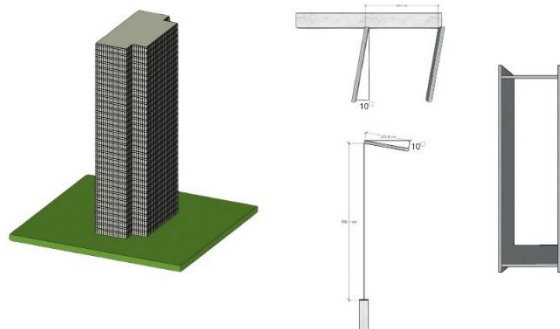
modelling bangunan sederhana tanpa menggunakan shading Gedung brilian tower
